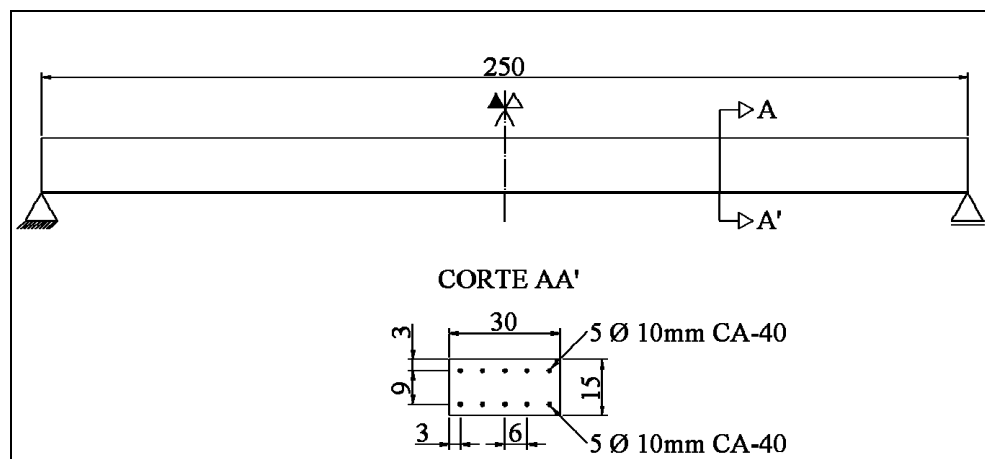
laje estudada por Anderberg (1978), dimensões em centímetros.
